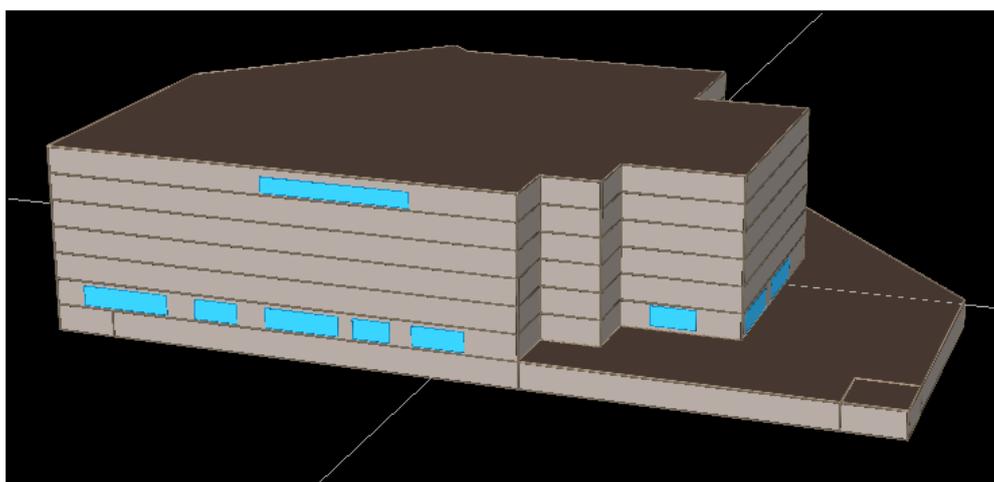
Vista 3D ECI de Albacete (fachada norte)
